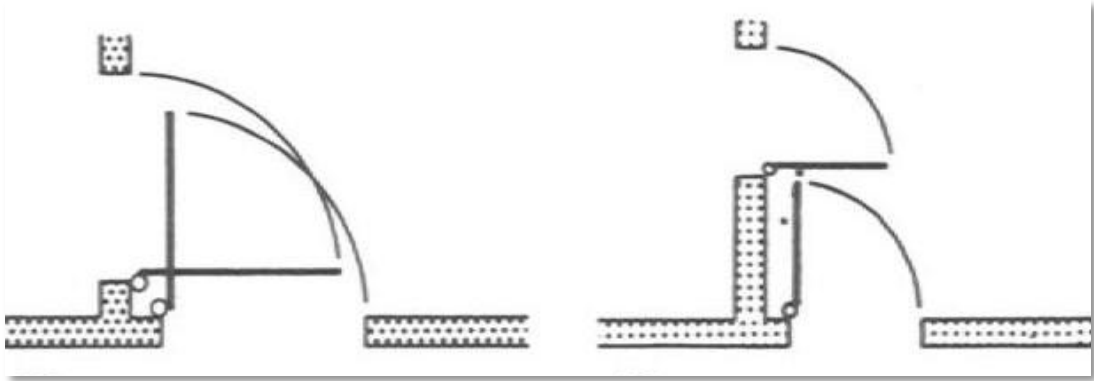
Dos puertas situadas erróneamente y dos bien situadas.
